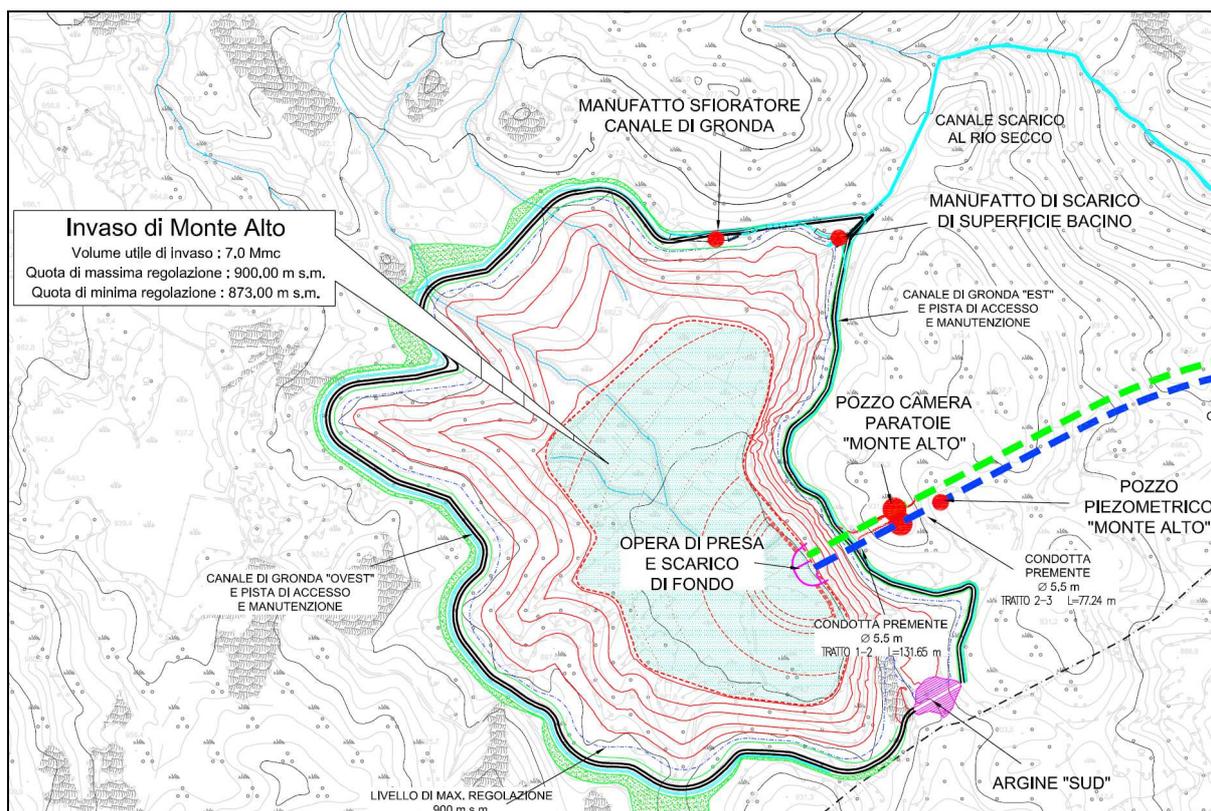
stralcio planimetrico delle opere in progetto del bacino di Monte Alto
